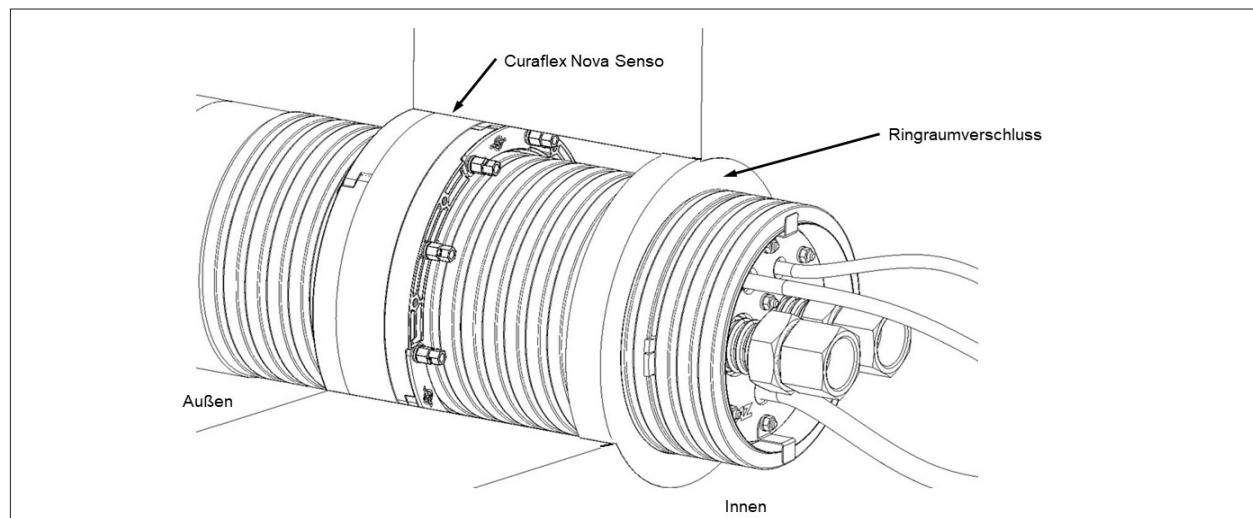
Ringraumverschlüsse Typ Kellerdurchführung
